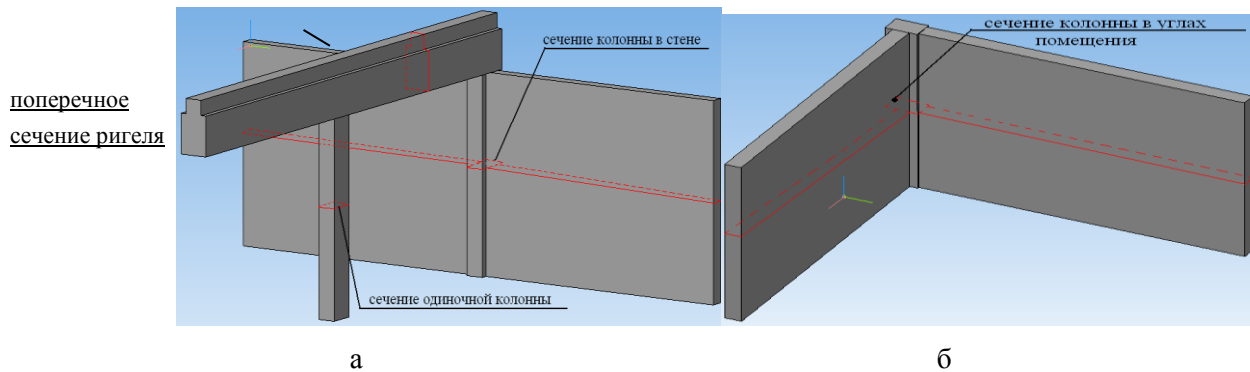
Общий вид и взаимное расположение рассматриваемых конструкций помещения: а – опирание ригеля на колонну в стене; б – угловая колонна с примыкающими стенами
